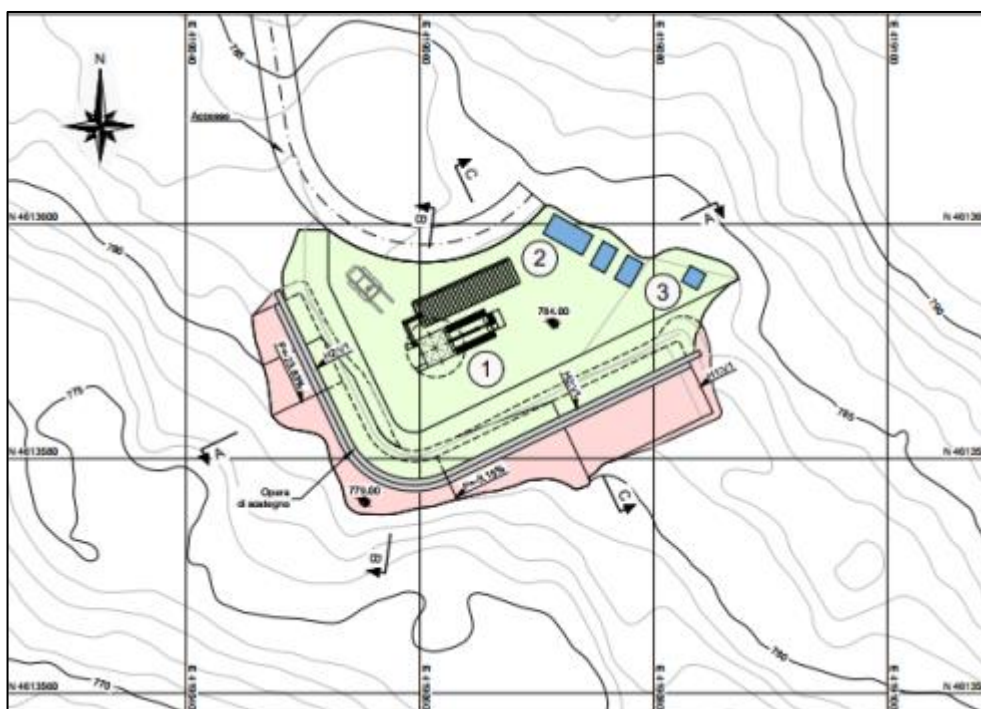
Ambito Pizzone - Area di cantiere CA.PV – Pozzo estrazione fumi della centrale
